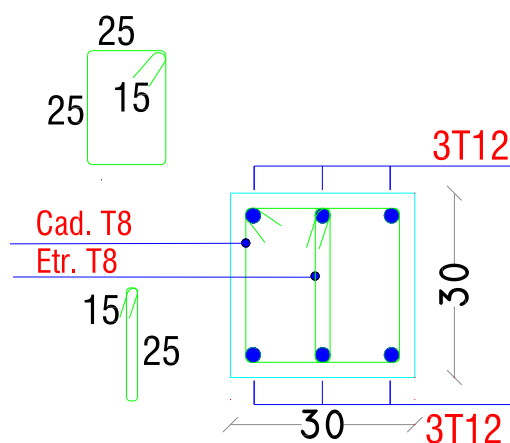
Ferrailage des poutres secondaires pour RDC, 1<sup>er</sup> Etage et 9<sup>ème</sup> Etage.
